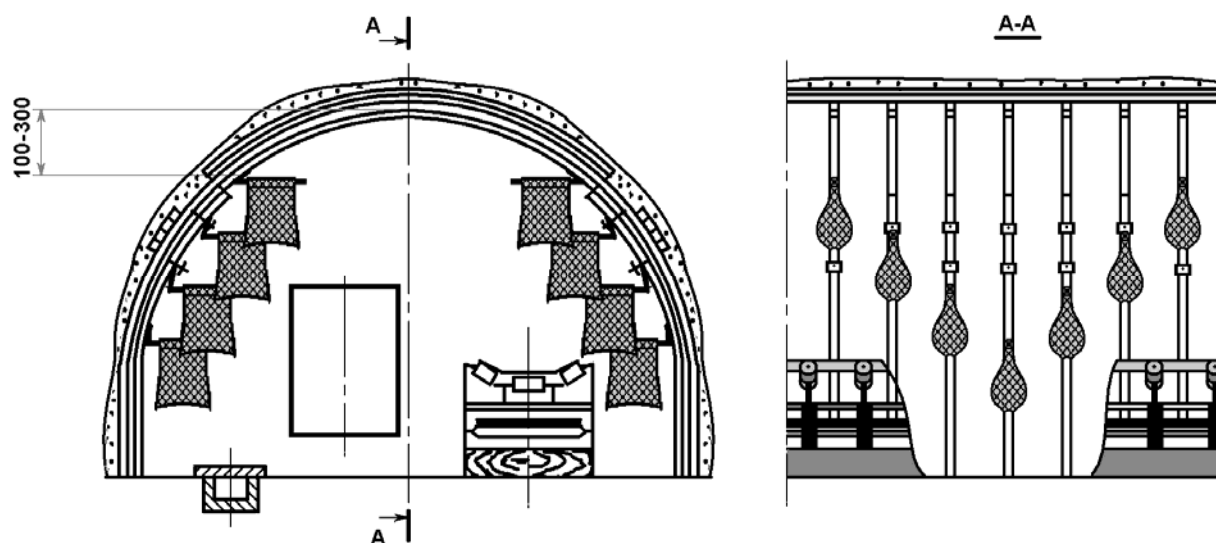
Схема установки водяного заслона из водяных карманов
